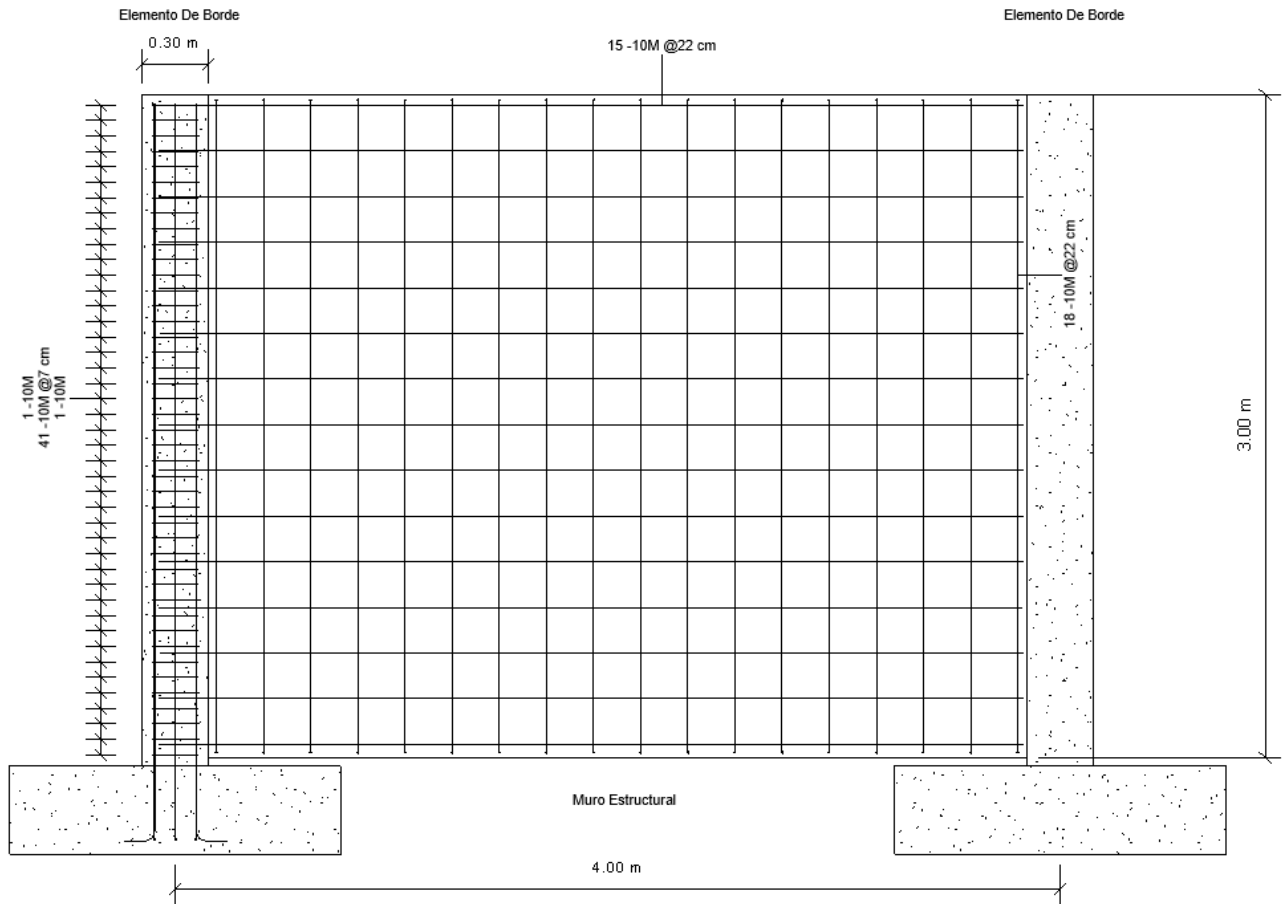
Dimensiones y armado de refuerzo del muro estructural para el sistema de 3 pisos
